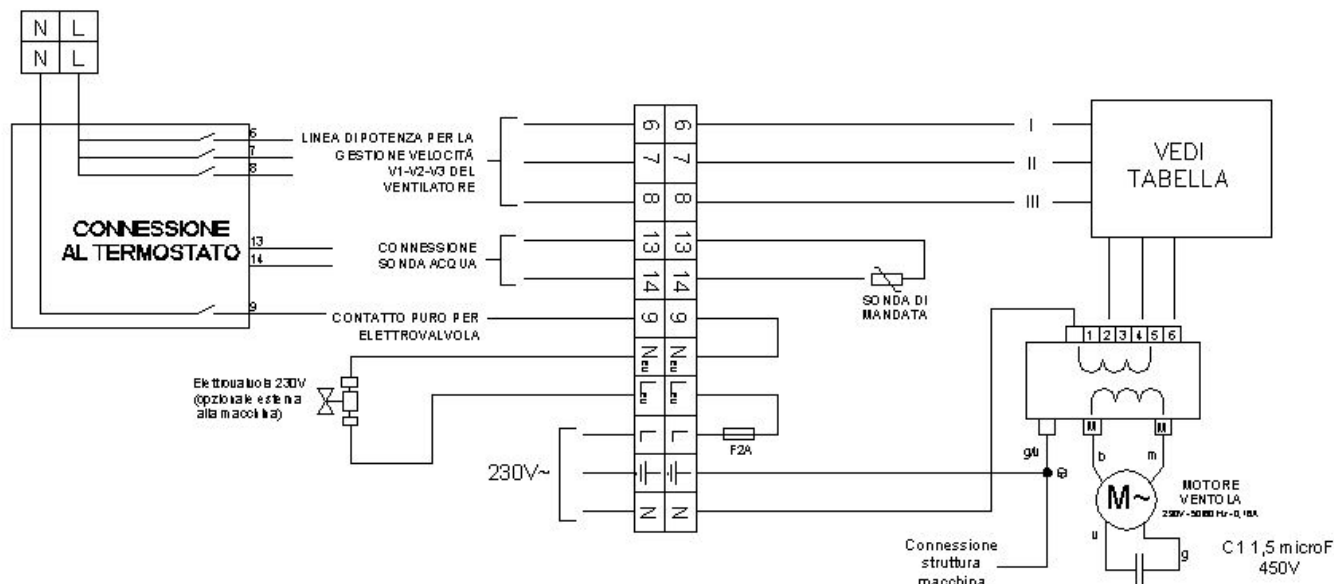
Schema elettrico ventilconvettore - termostato remoto di controllo (non installato a bordo macchina)
